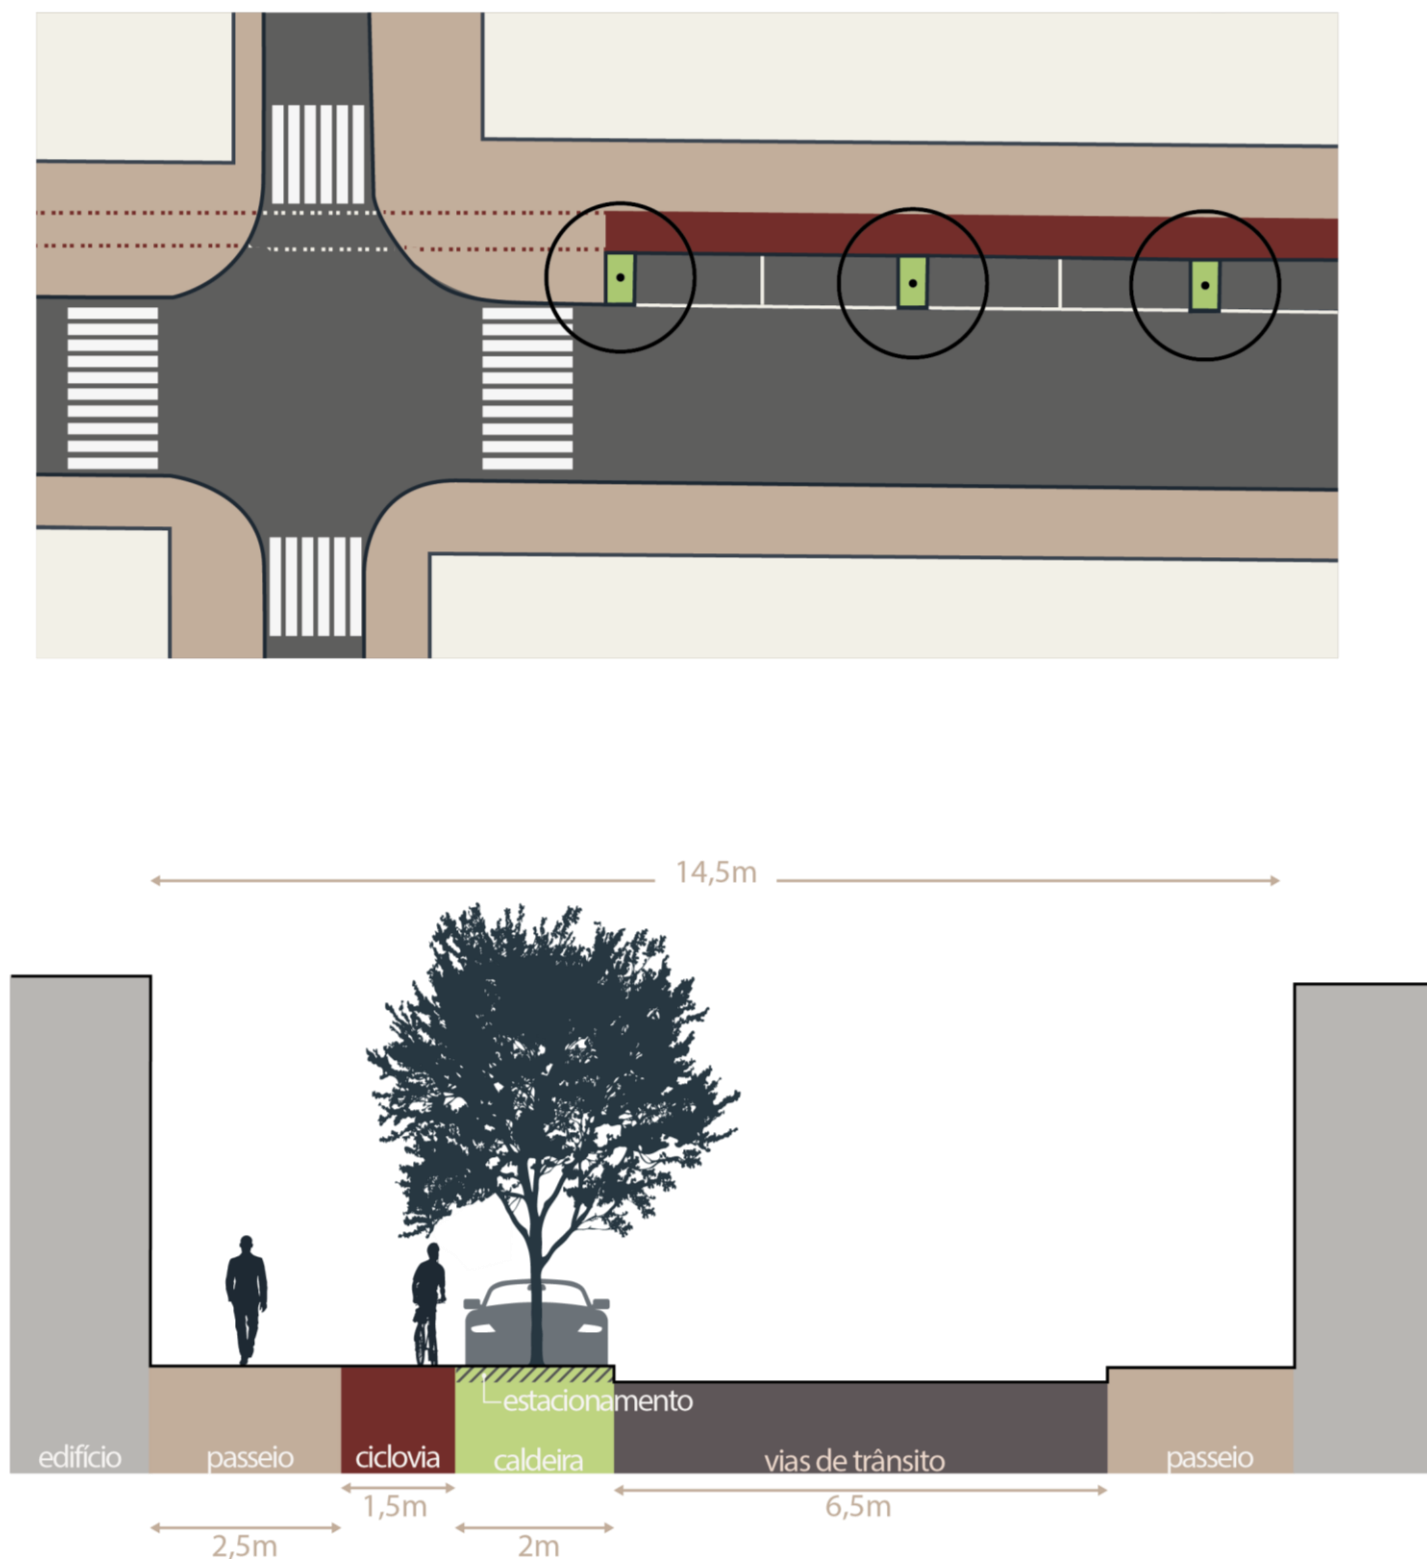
Perfil tipo proposto para a rua 20 (fonte elaboração própria)
